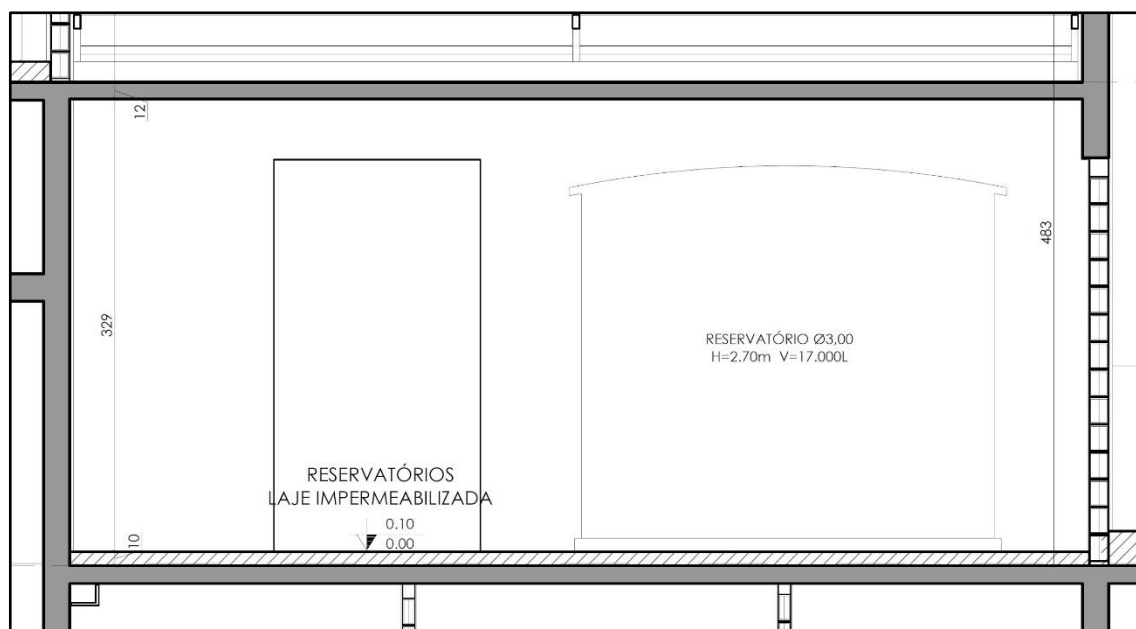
Corte parcial do barrilete - caso 2 (fonte: empreendimento estudo de caso)
